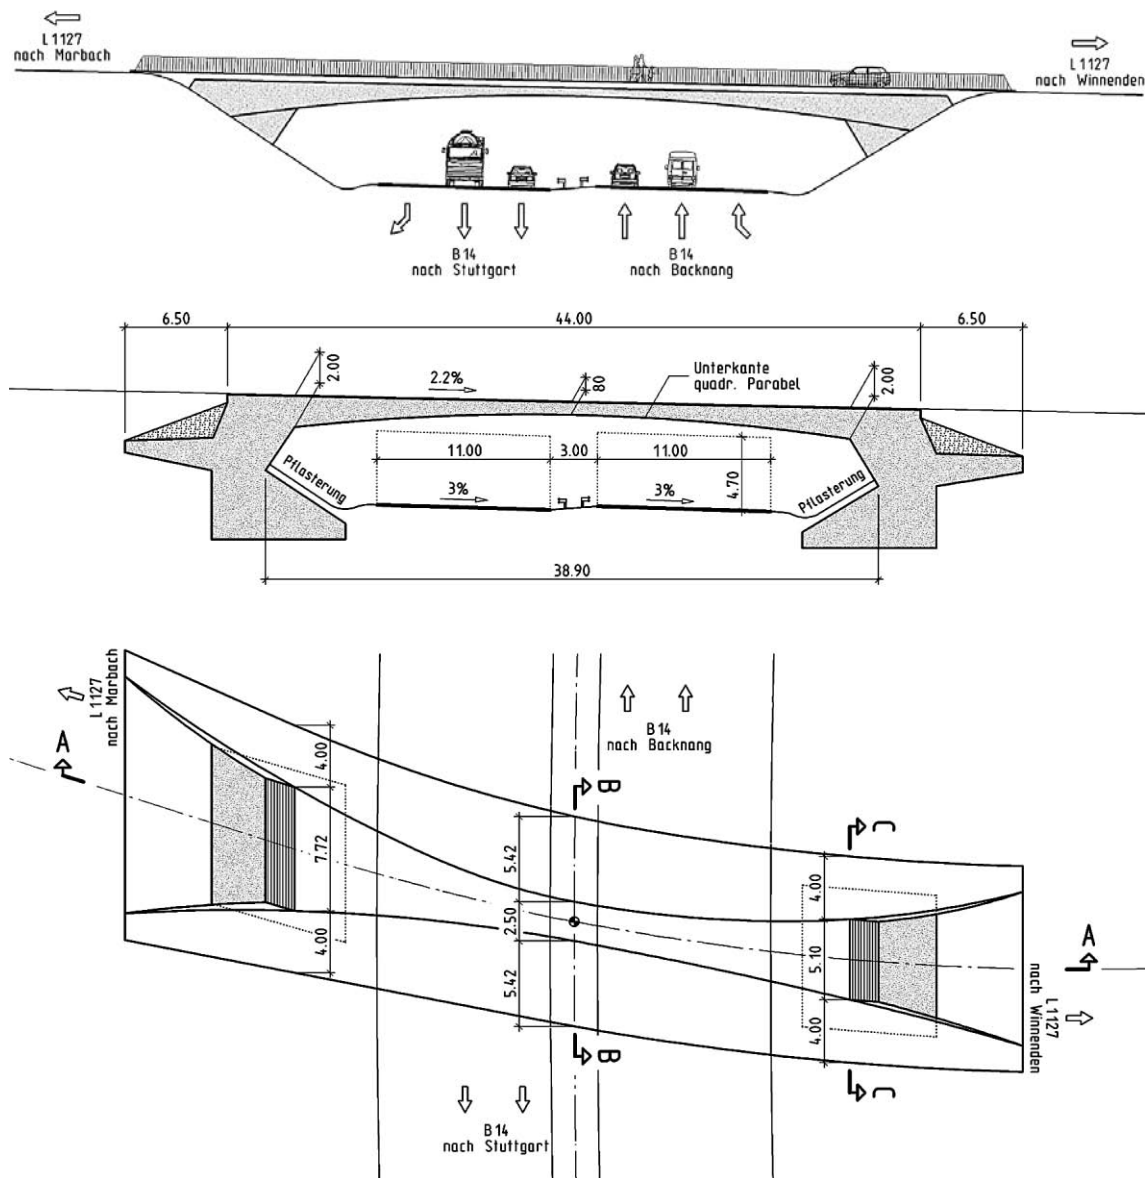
Bauwerk 5, Winnenden: Längsansicht, Längsschnitt A - A und Grundriß
